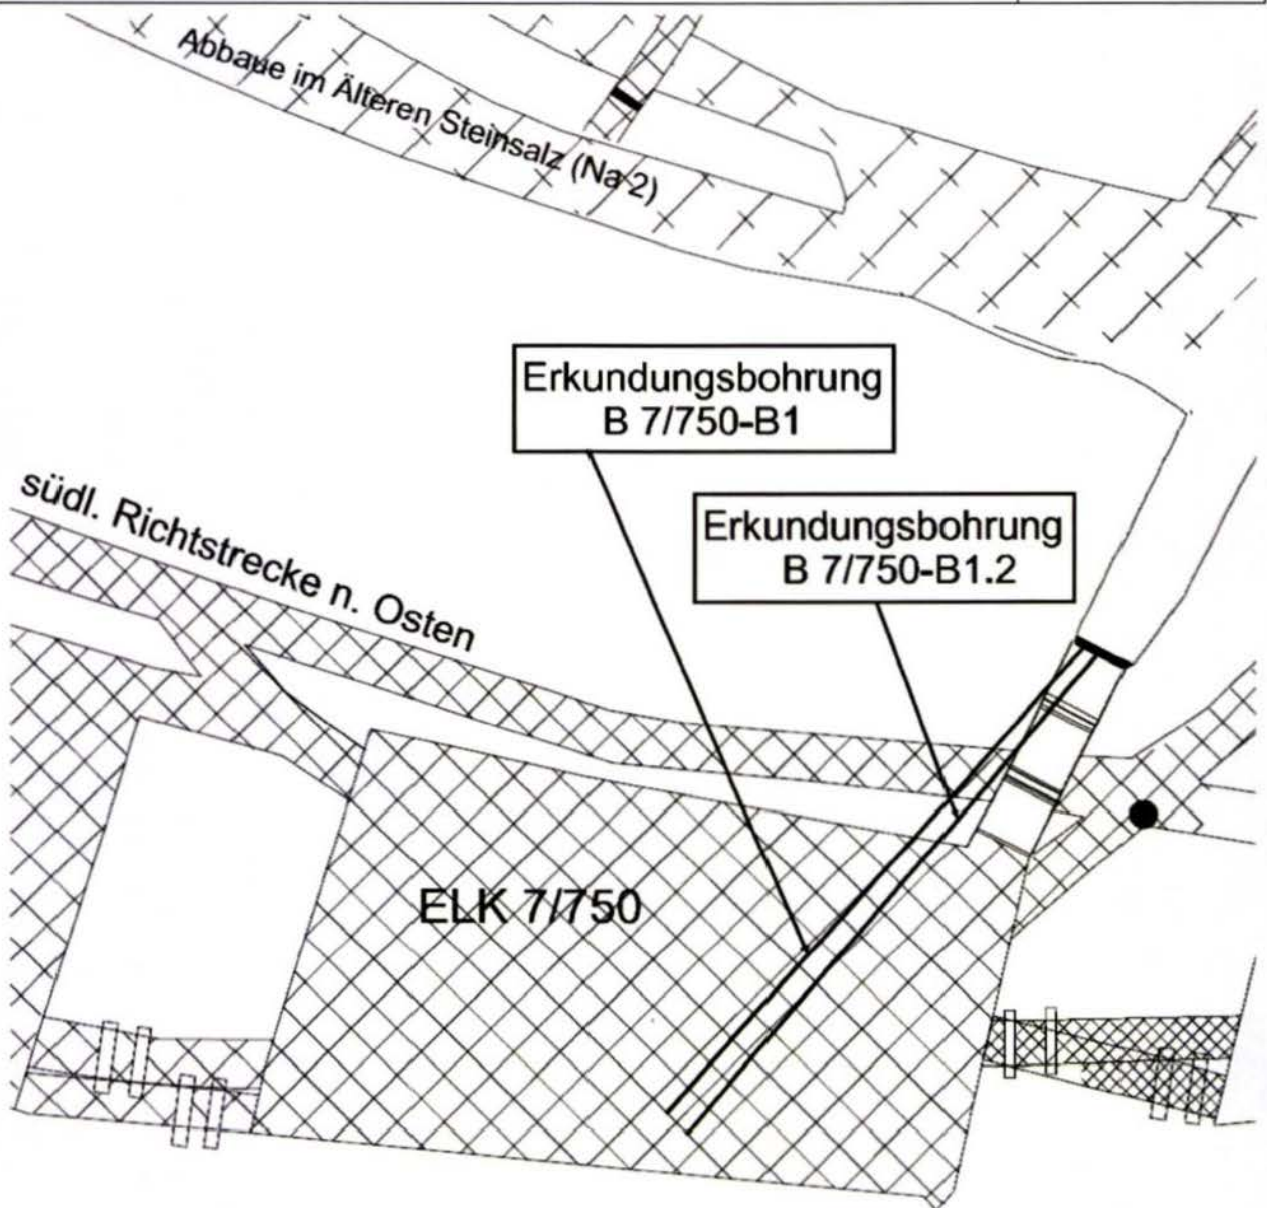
Ausschnitt aus dem Grundriss der Einlagerungskammer 7 (ELK 7/750) auf der 750-m-Sohle mit Lage der Erkundungsbohrungen B 7/750-B1 und B 7/750-B1.2
